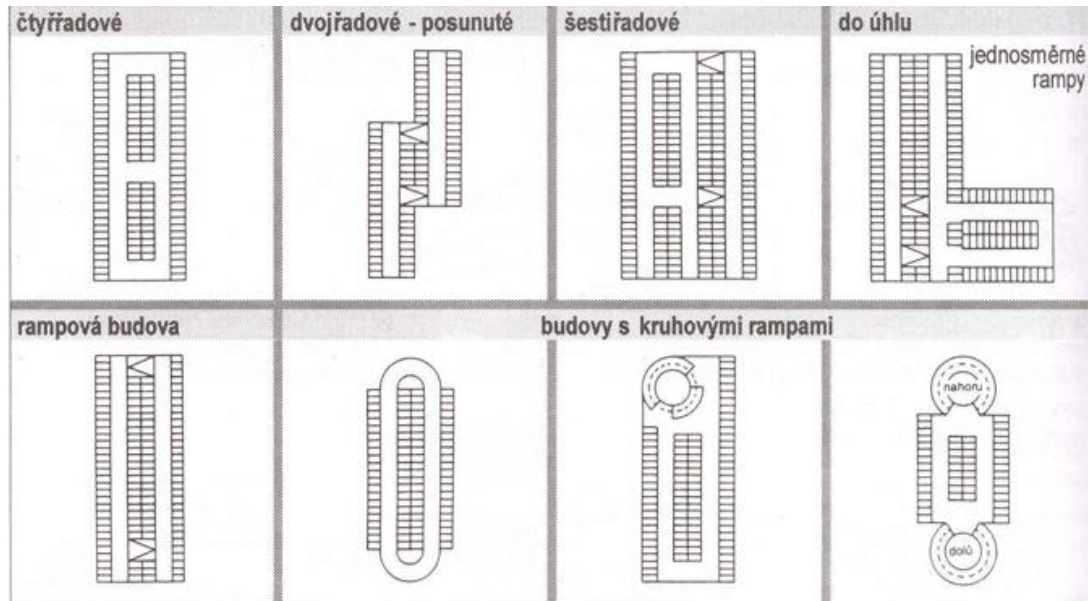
Parking s kruhovými rampami v rozích budovy [3]
